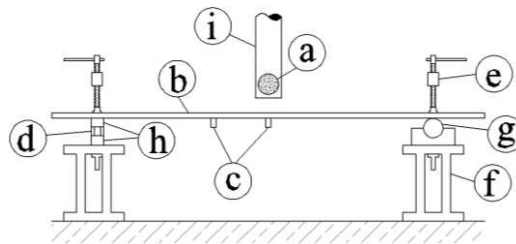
Montaje del ensayo de impacto a) Esfera de acero b) viga de acero c) acelerómetros d) anillo de fuerza e) prensa tipo “c” f) vigas de acero debajo de los apoyos g) rodillo de acero que emula el apoyo móvil h) planchuelas metálicas i) tubo de pvc.
